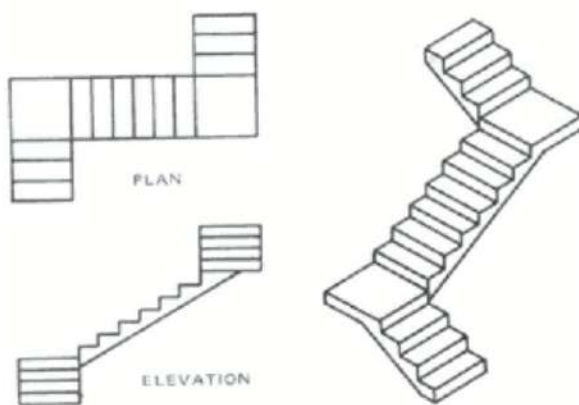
مسقط أفقي وجانبي و رسم ثلاثي الأبعاد لسلم مستقيم نصف
